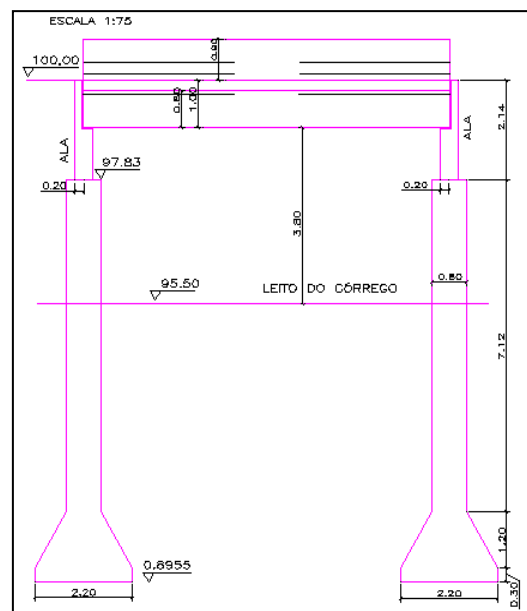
Ponto de concreto armado – corte Longitudinal
